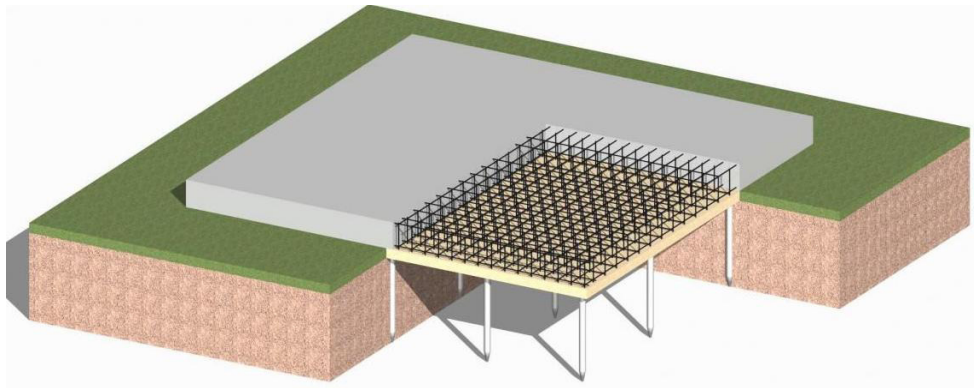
Схема фундаментної плити у вигляді плоскої бетонної монолітної плити, укріпленої палями
